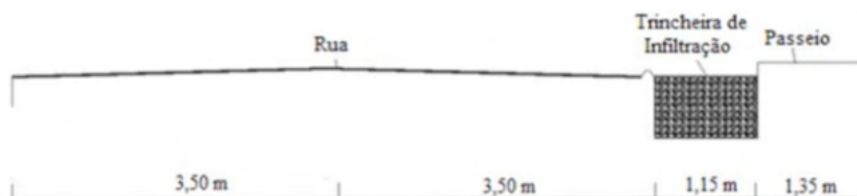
Detalhe da Disposição das Trincheiras de Infiltração.
